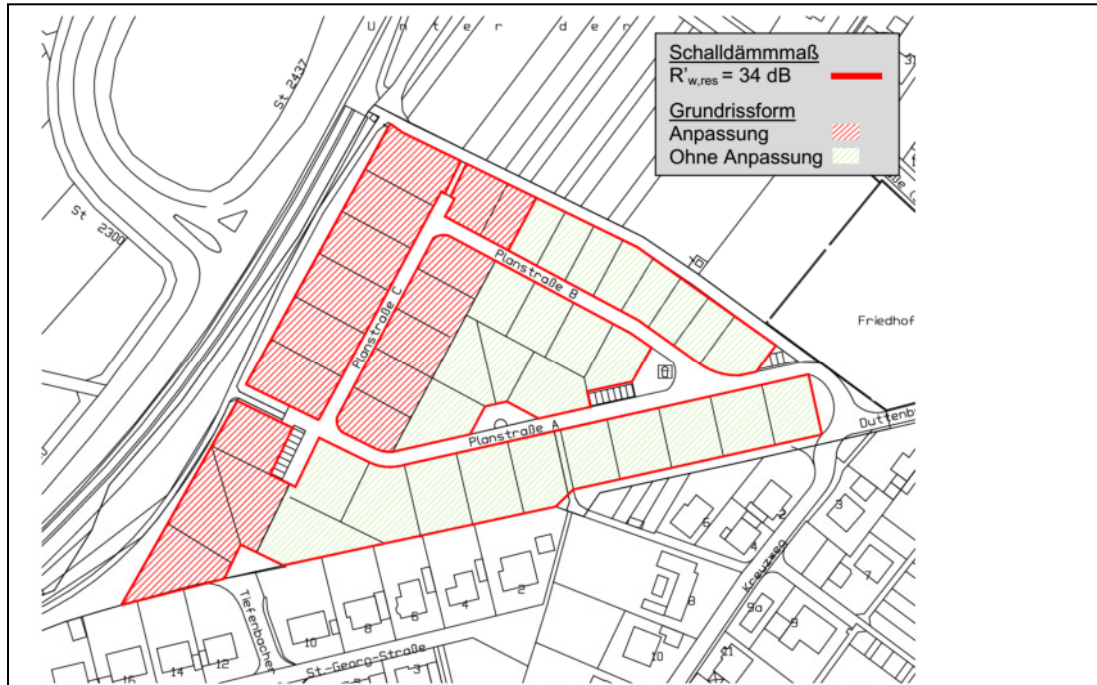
Erforderliche resultierende Mindestschalldämmmaße  $R'_{w,res}$  und Grundrissformen
